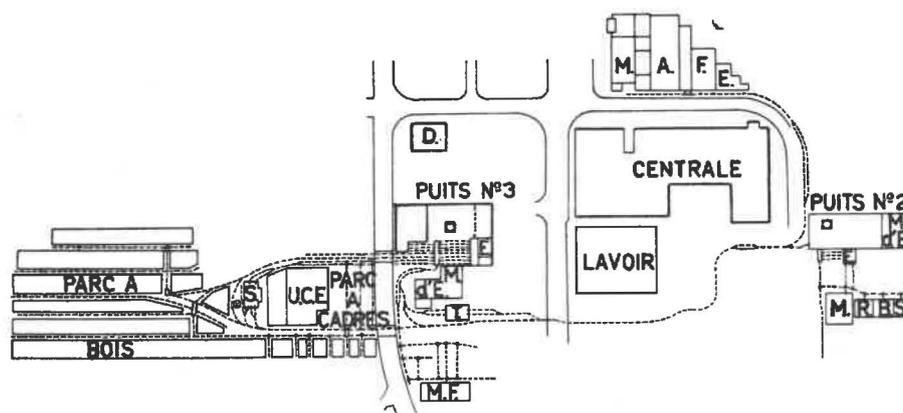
Plan de la paire aux bois et raillage Decauville
